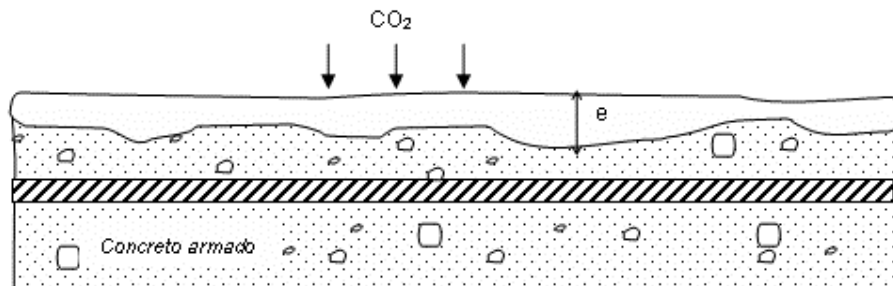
CARBONATAÇÃO DO CONCRETO ARMADO (ANDRADE, 1992)
